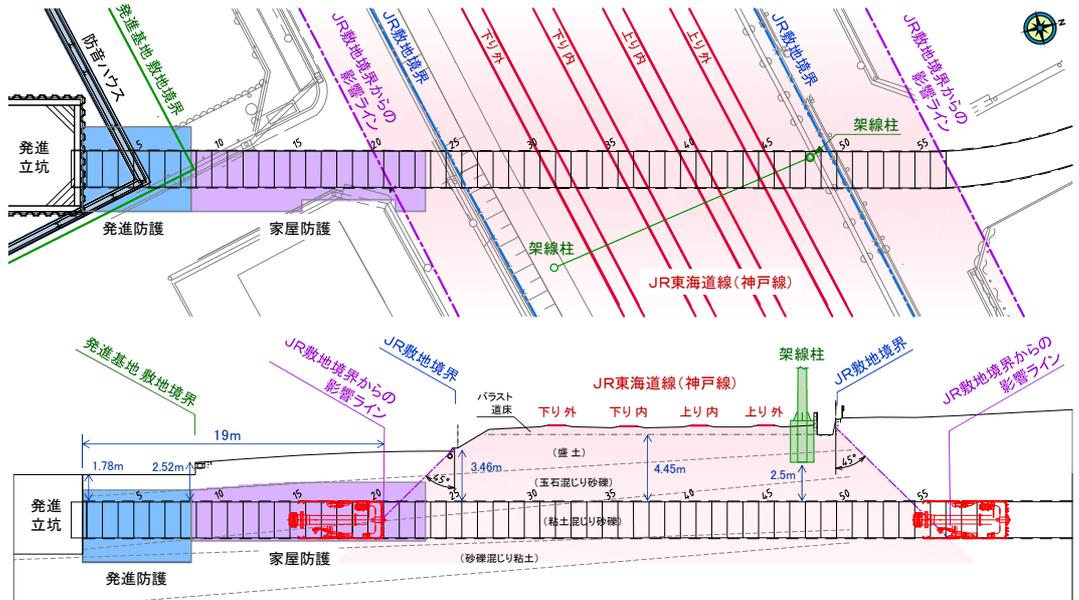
JR 東海道線（神戸線）横断部 平面・縦断概要図
